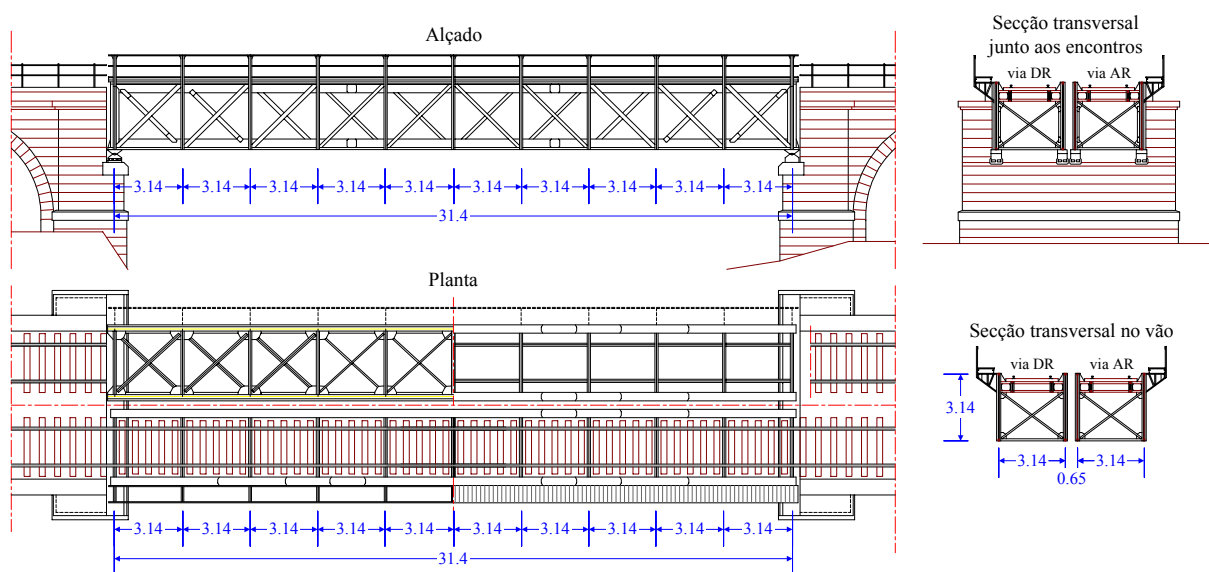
Alçado, planta e secções transversais da ponte de Sacavém.
